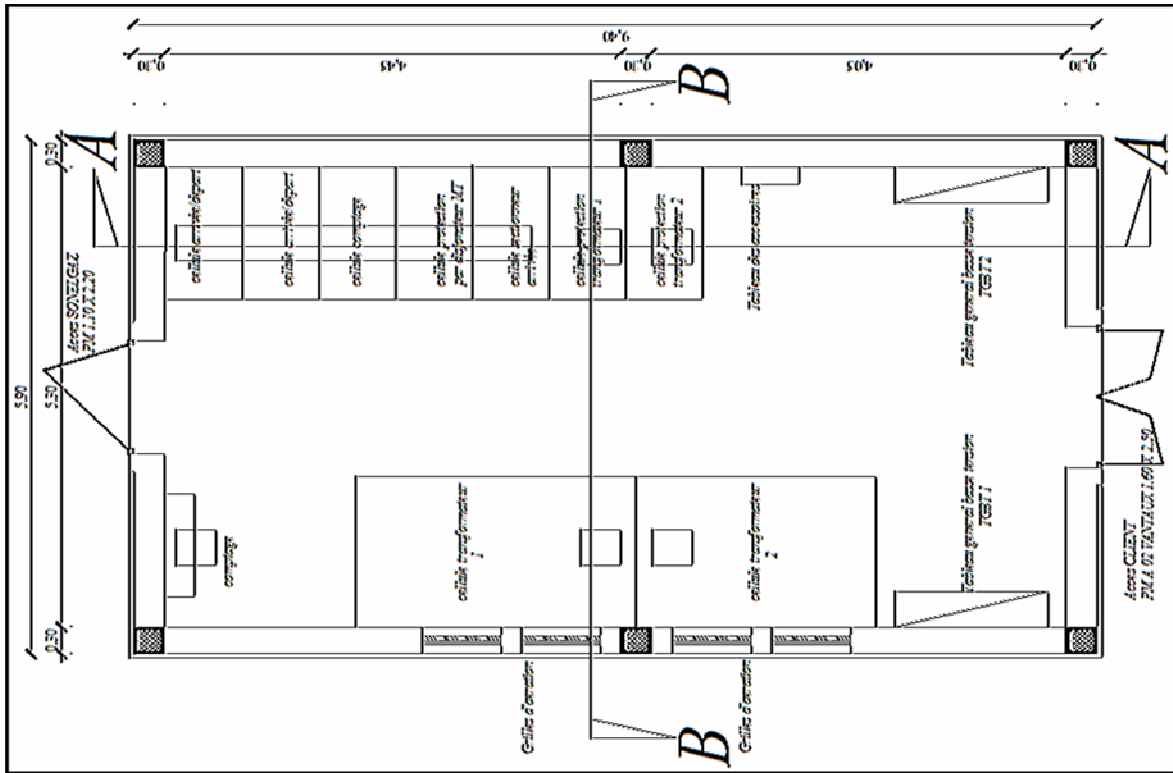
Plan d'équipement d'un poste livraison à comptage MT
